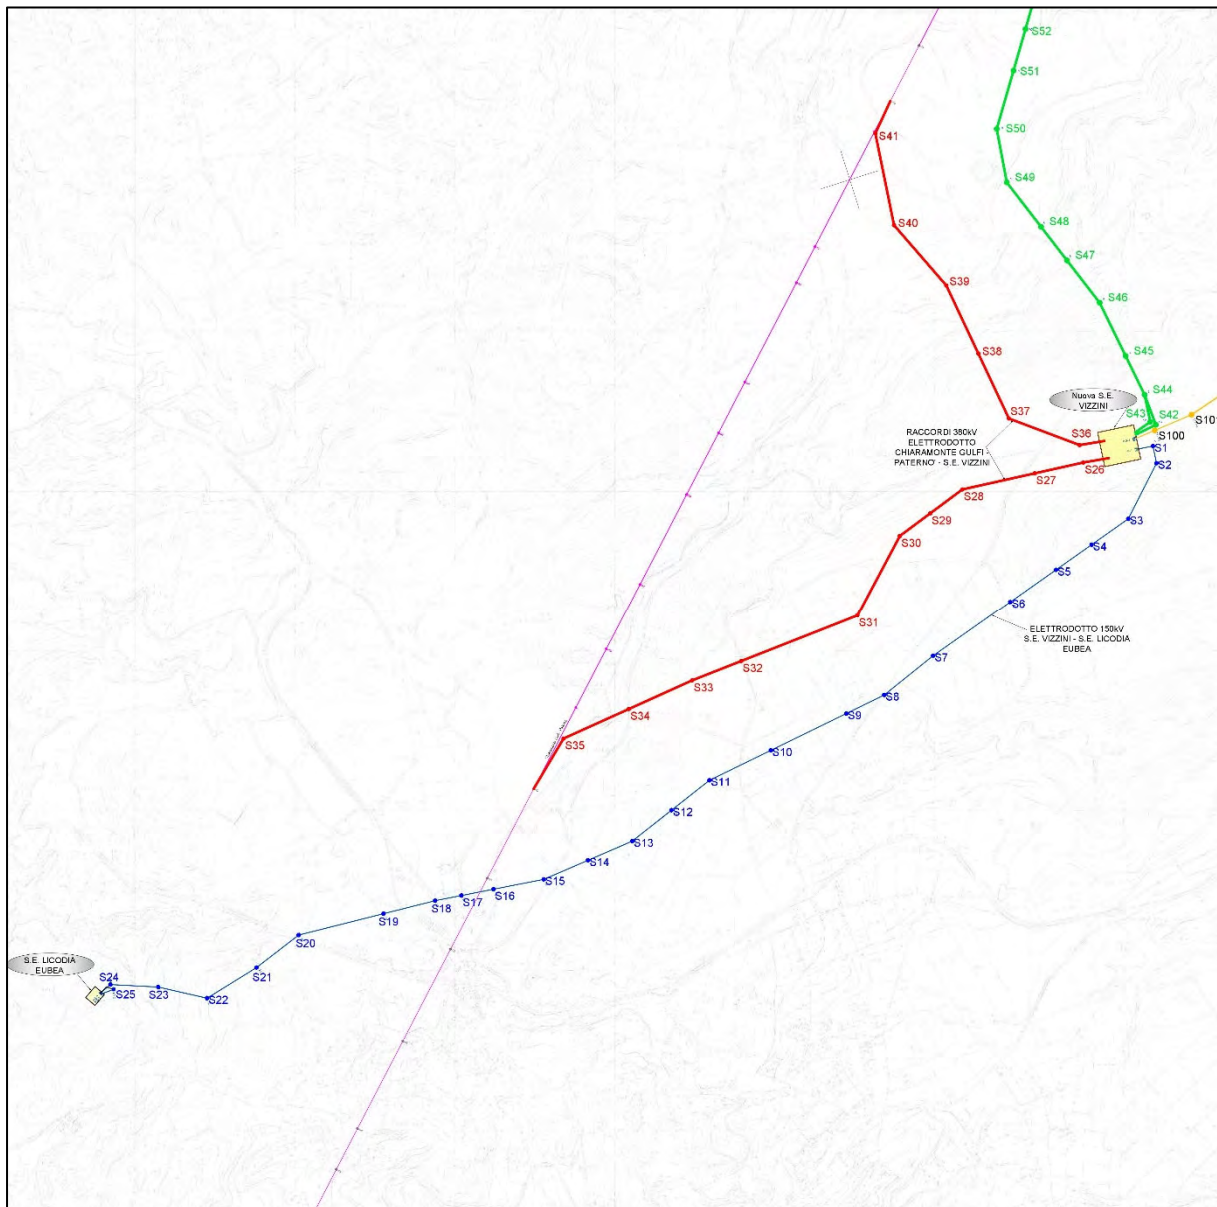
Planimetria con ubicazione prelievi linee foglio 02
